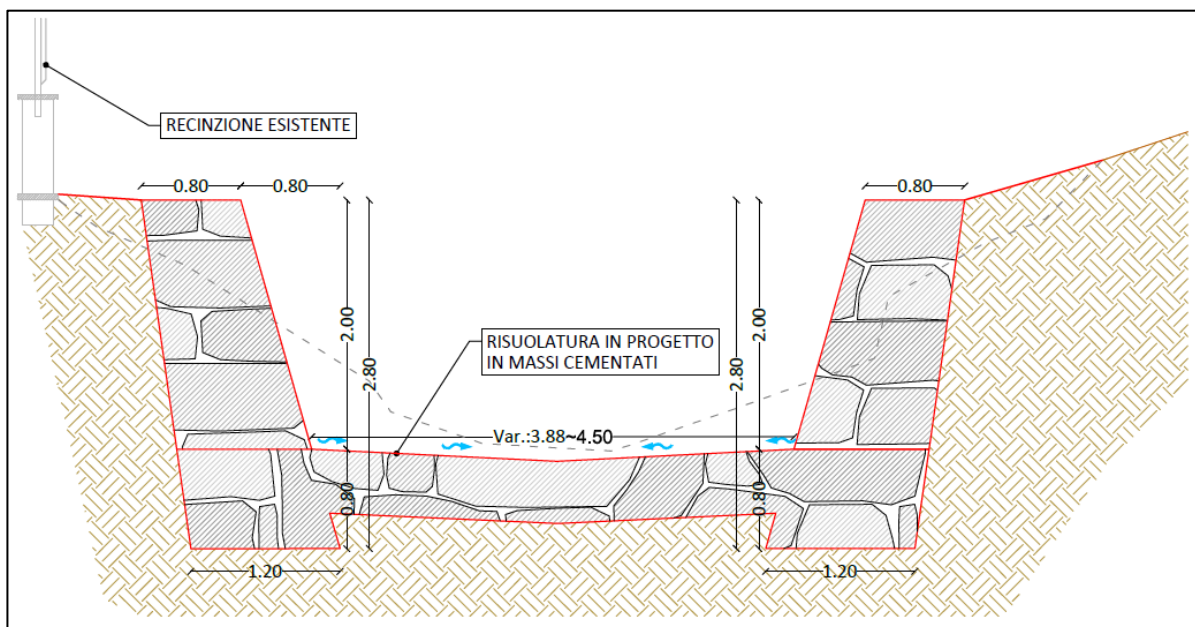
Sezione tipo opera in progetto del primo tratto dell'Intervento A.
